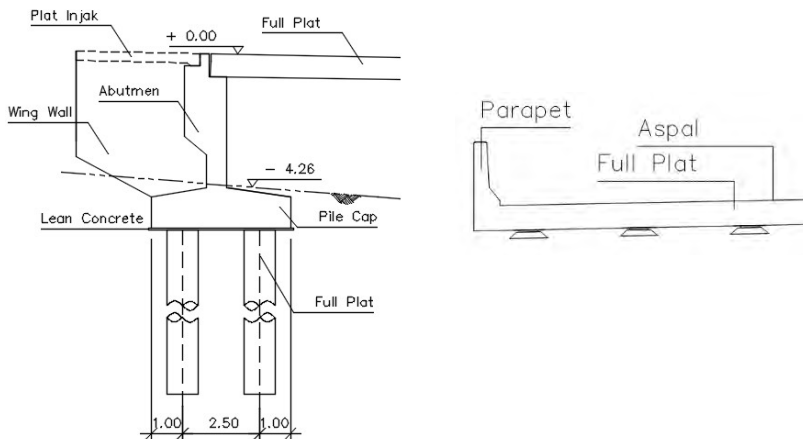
1 Perencanaan Abutment A1 (Sisi Sragen)
